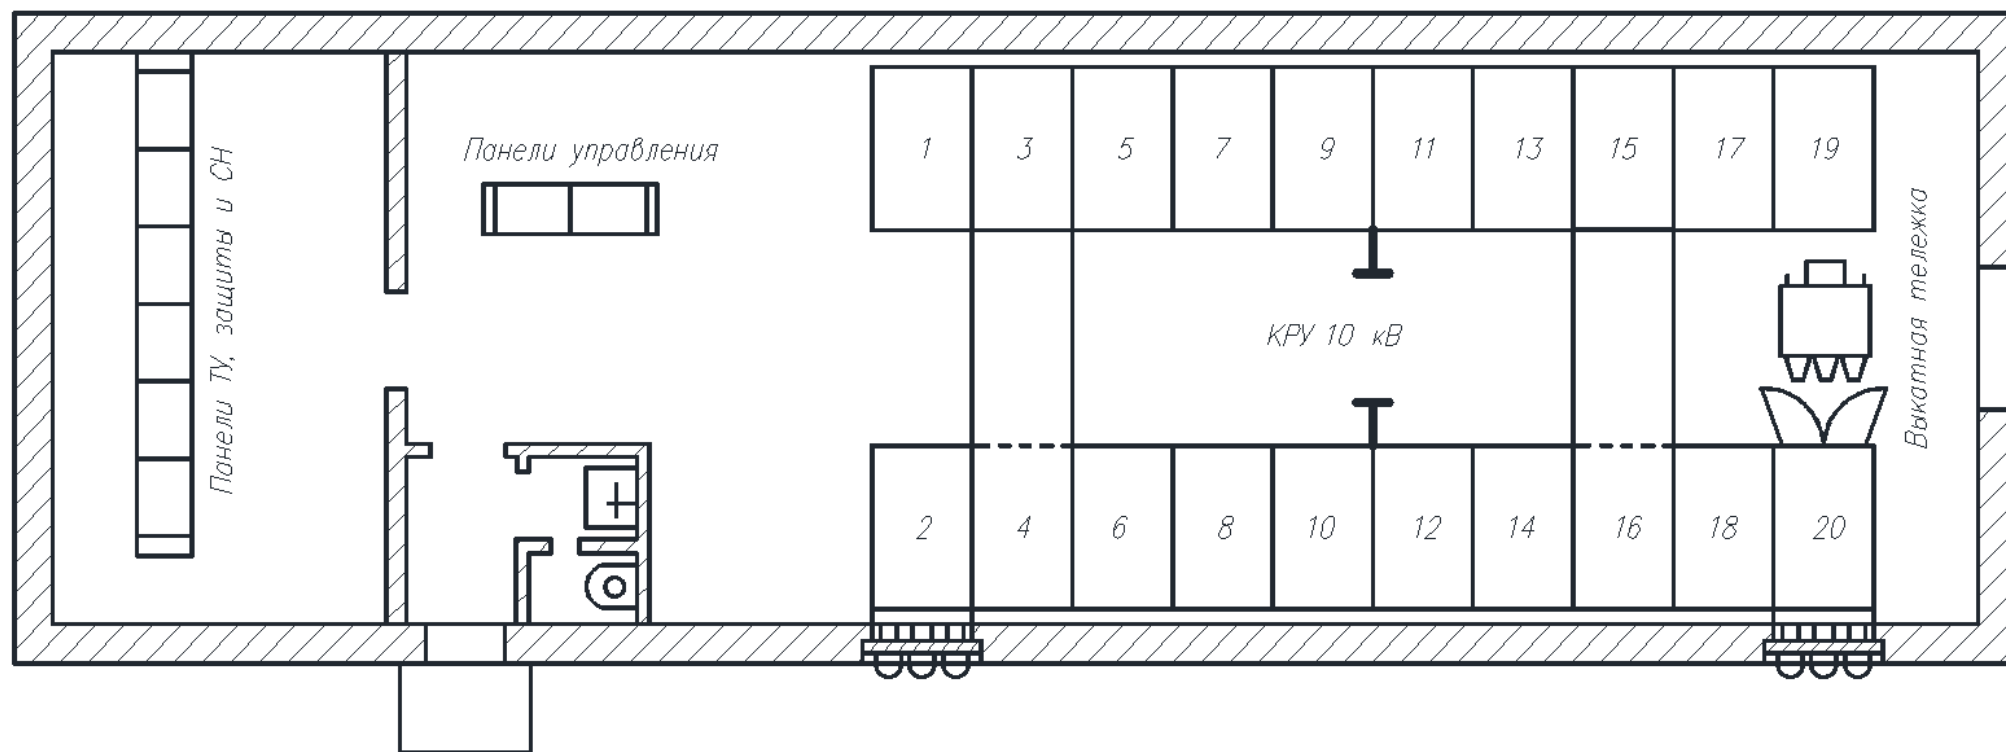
План ЗРУ с размещением ячеек КРУ
